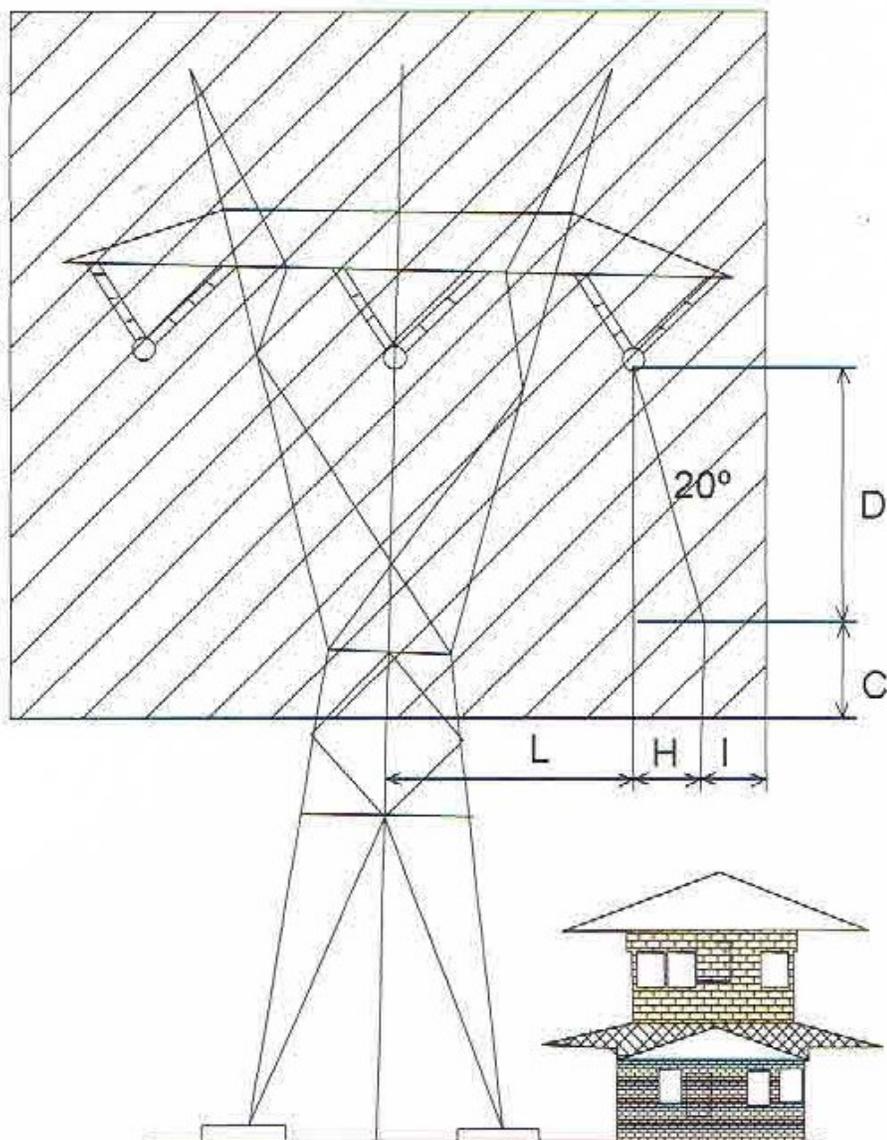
Ruang bebas SUTT 66 kV dan 150 kV tiang baja
